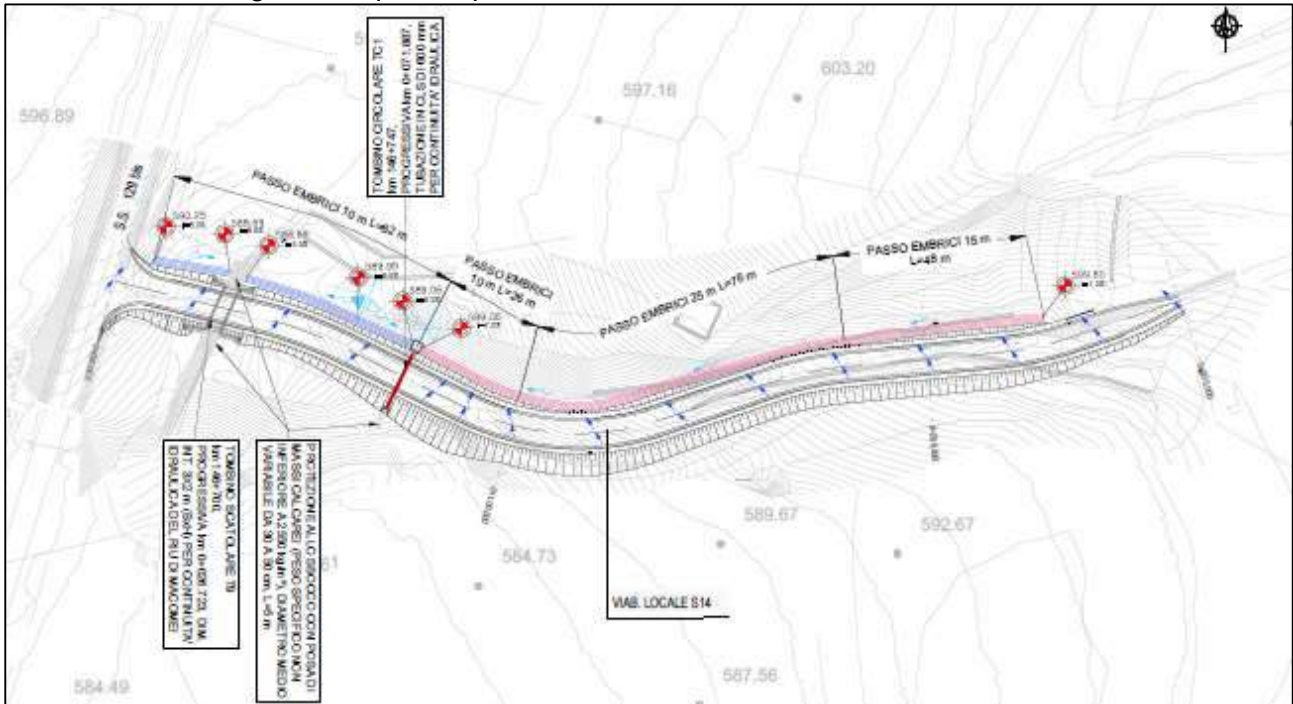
Stralcio planimetrico intervento S14-Risoluzione accesso C.S. al km 146+780
